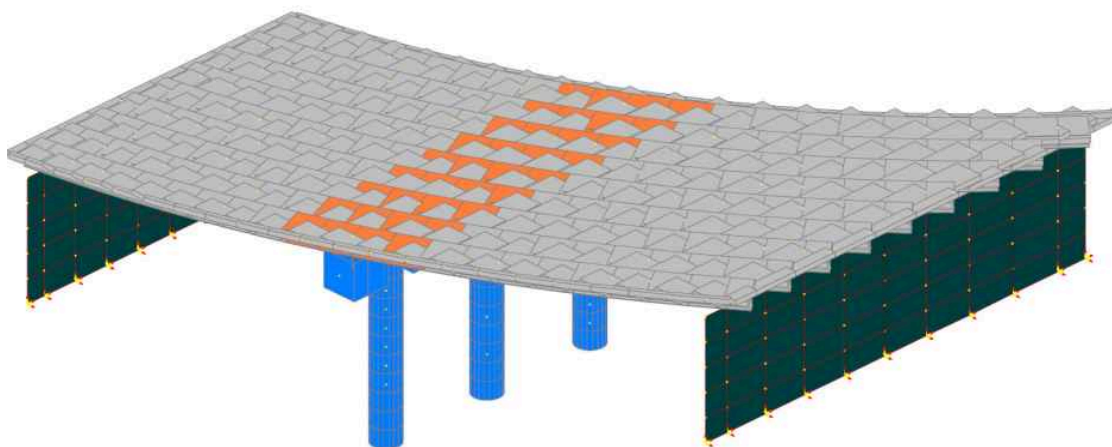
Modélisation 3D du tablier à poutres en acier avec dalle mince en béton avec ADA
